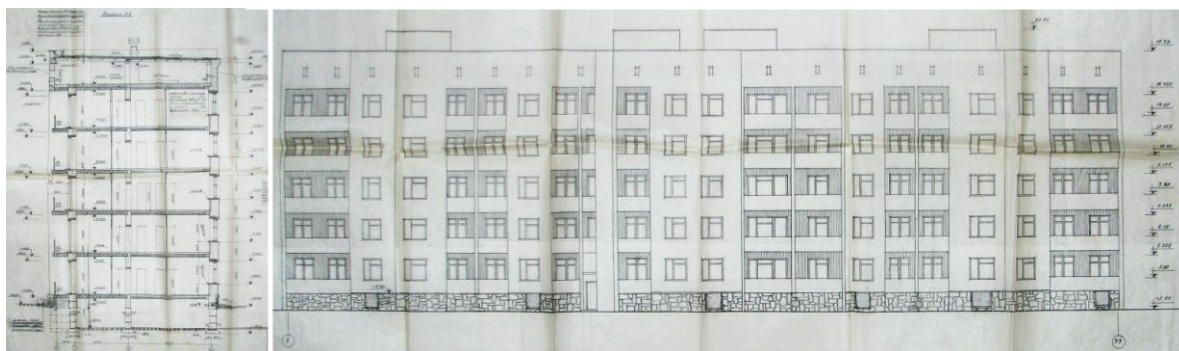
Чертежи разреза и уличного фасада жилого дома по ул. Урицкого, д. 98
